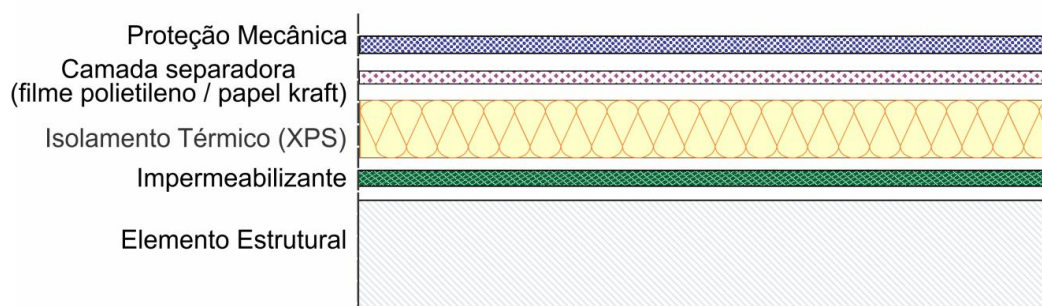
Aplicação de impermeabilizante asfáltico com isolamento térmico
